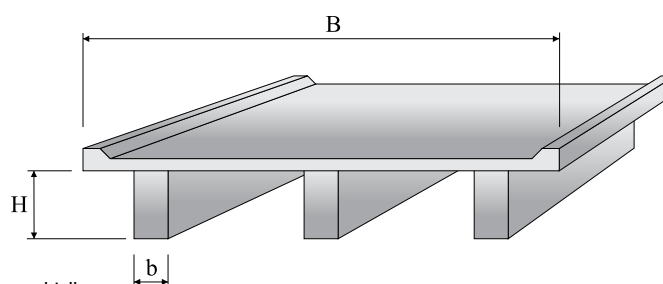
Bjelkebru med rektangulære betongbjelker
